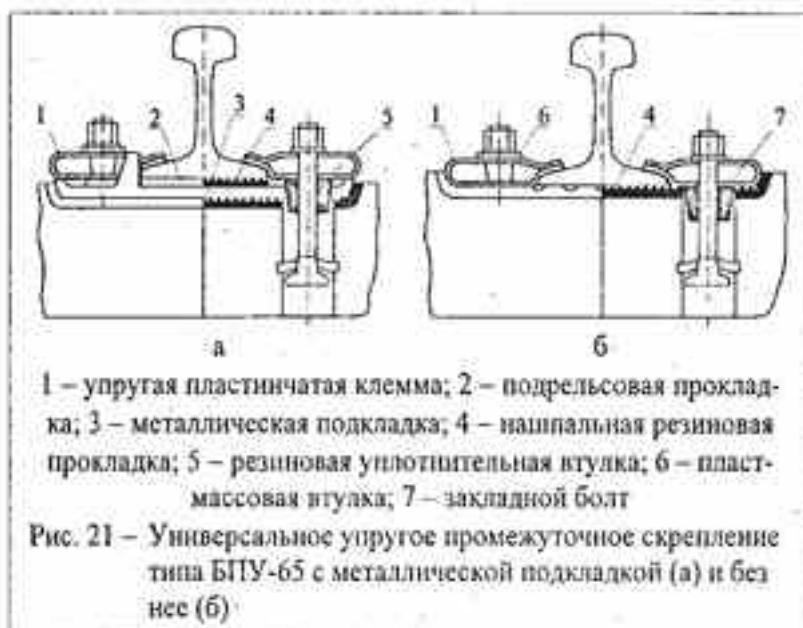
Универсальное упругое промежуточное крепление типа БПУ-65 с металлической подкладкой (а) и без нее (б)
